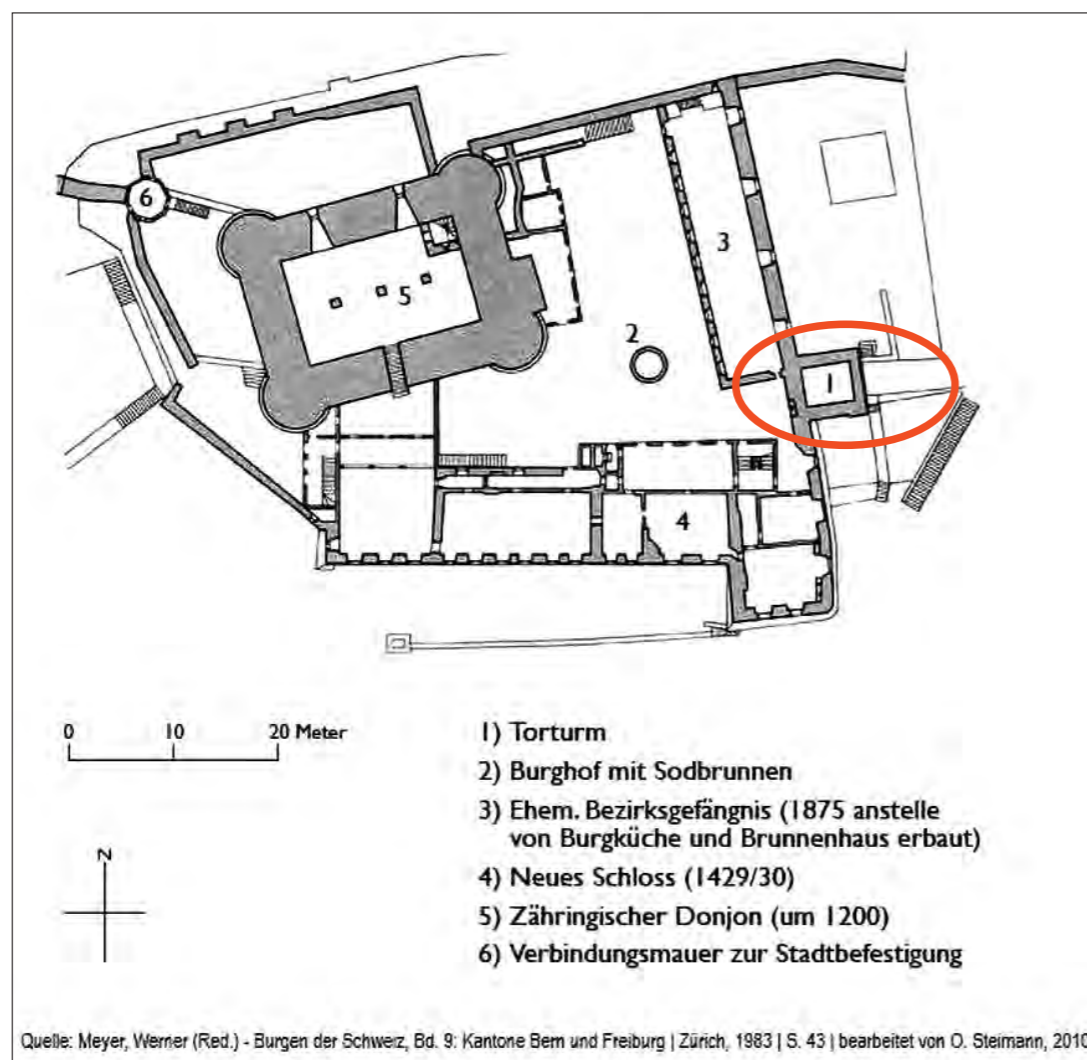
Grundriss der Anlage mit eingezeichnetem Bereich der Beobachtungen zu den Salzausblühungen. Plan von: <http://www.burgenwelt.org/schweiz/thun/object.php#historie>, 12.12.2019
